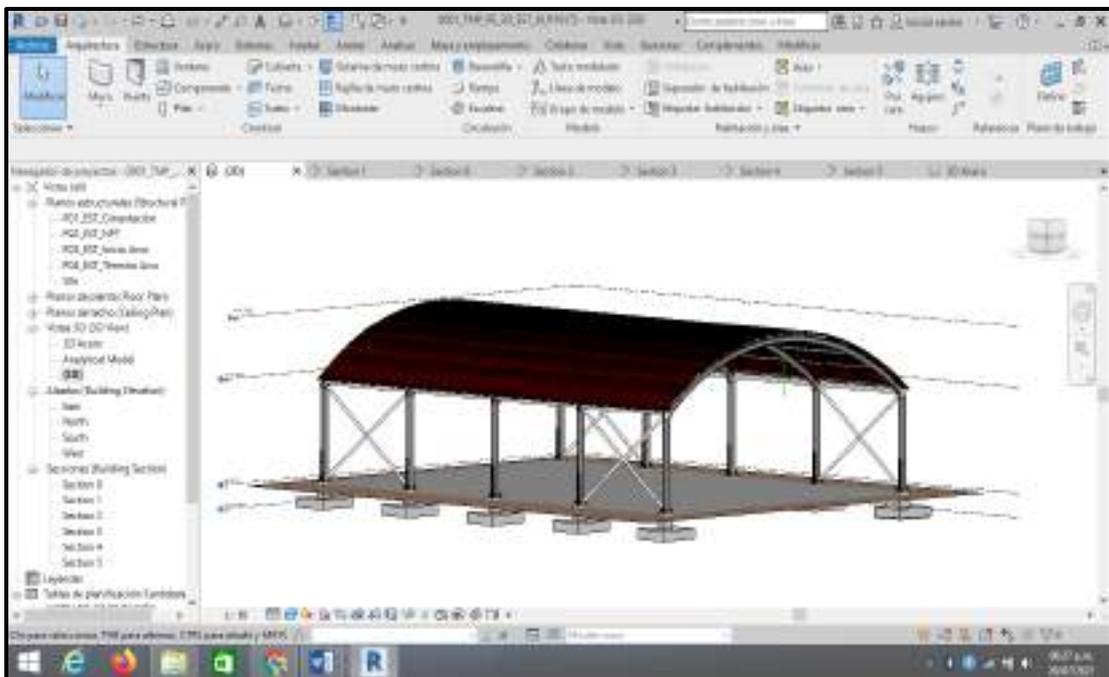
Vista 3D del proyecto de construcción de cobertura con estructura metálica.
